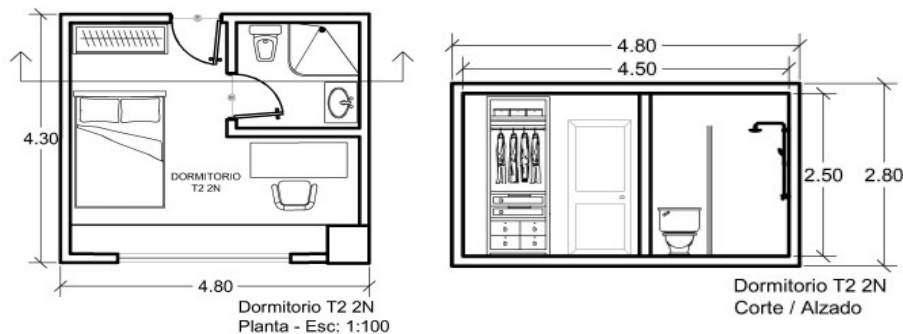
Planta y alzado de dormitorio individual con baño completo esc. 1:100
